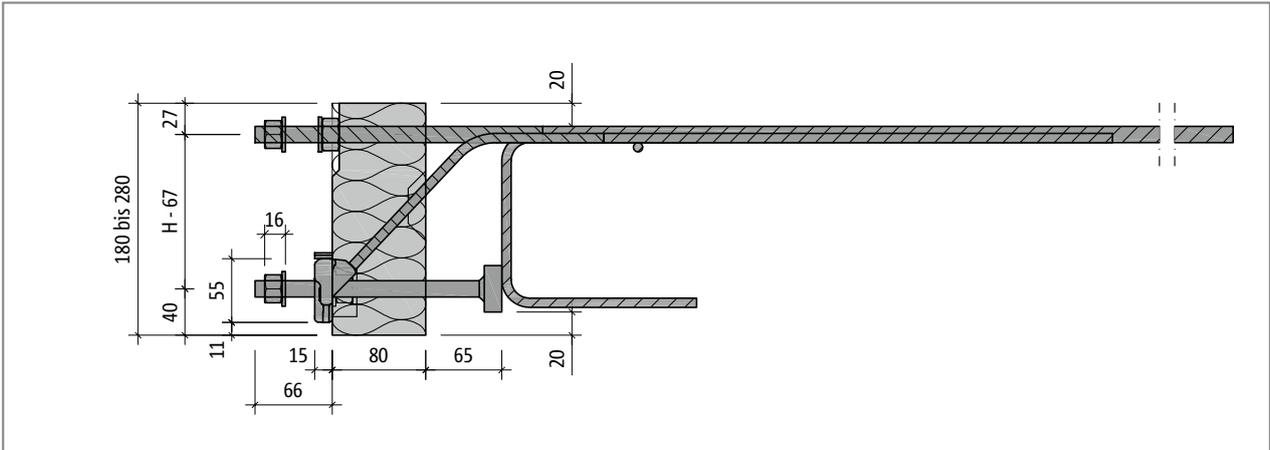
Schöck Isokorb® T Typ SK-M1-V1: Produktschnitt
